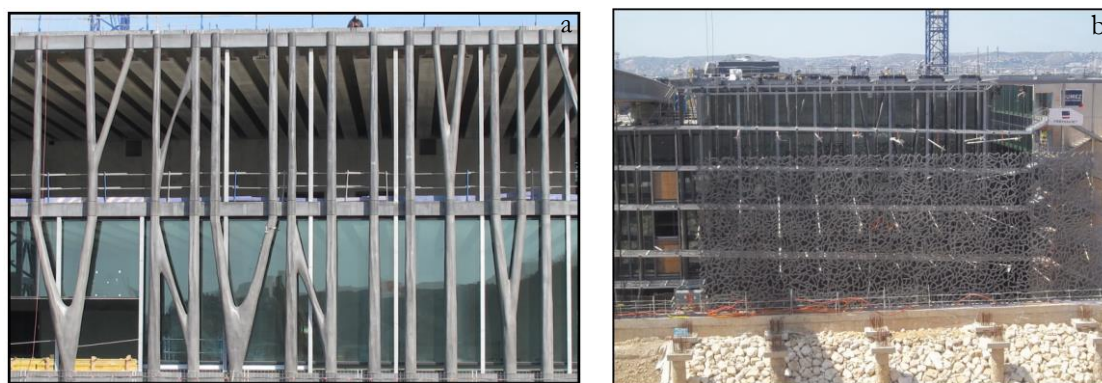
a) Colunas de suporte da fachada; b) Fachada reticulada a ser aplicada.
